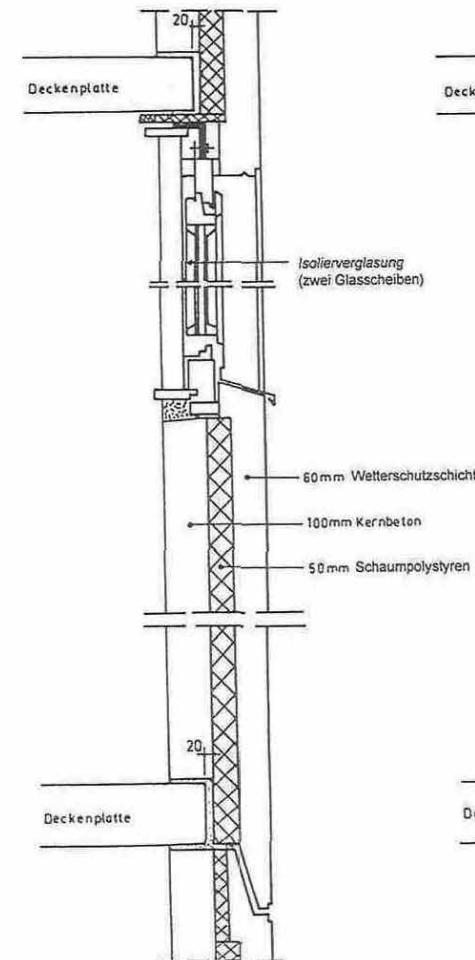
Nichttragende Außenwand mit Fenster, Deckenaufleger und Lagerfuge - Wandaufbau
